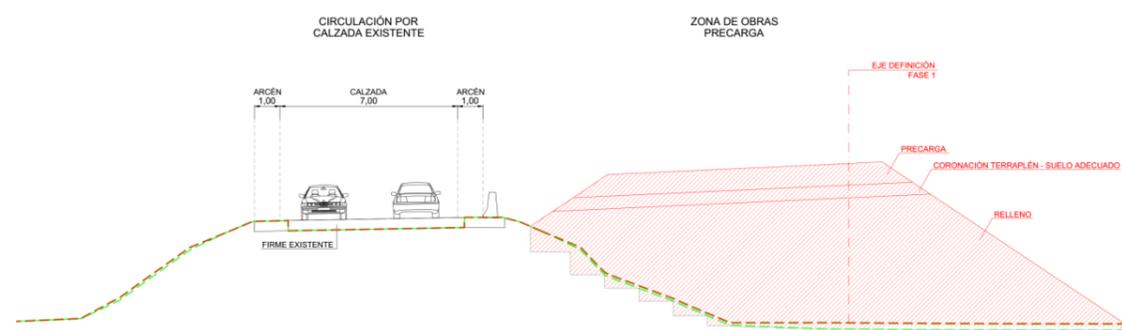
En rojo la zona de obras de Fase 1, con precarga.
